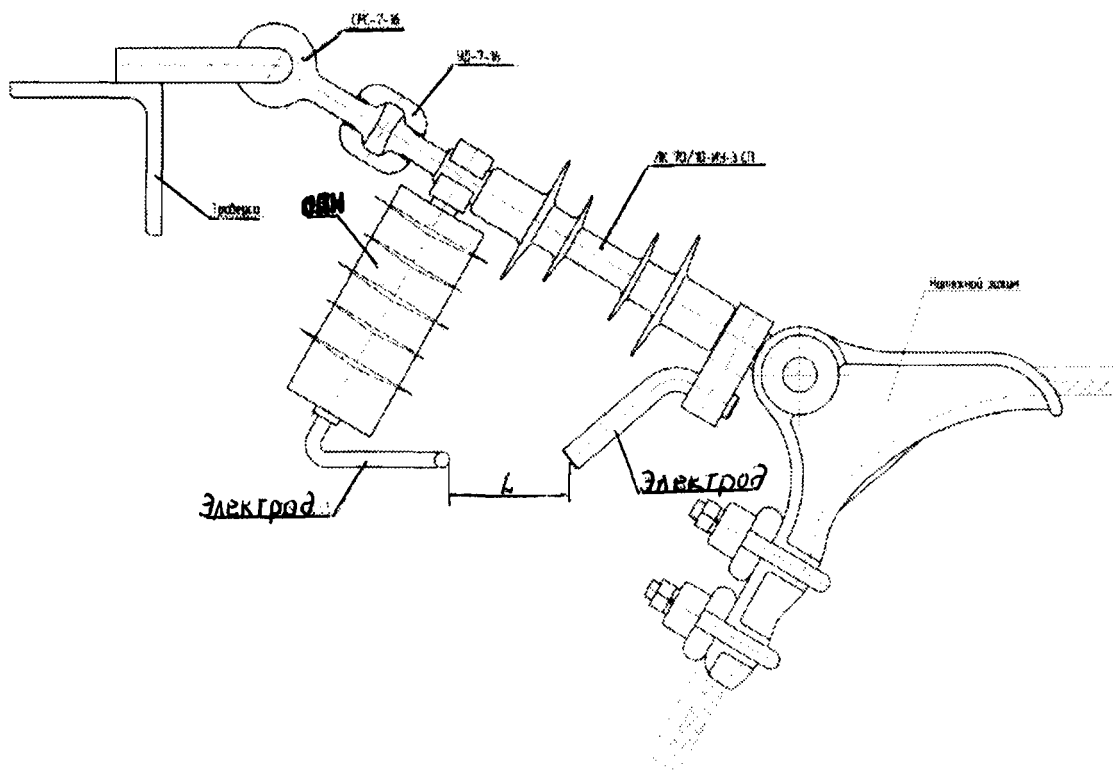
Схема монтажа УЗПН-10-АП на анкерной опоре с полимерными изоляторами
